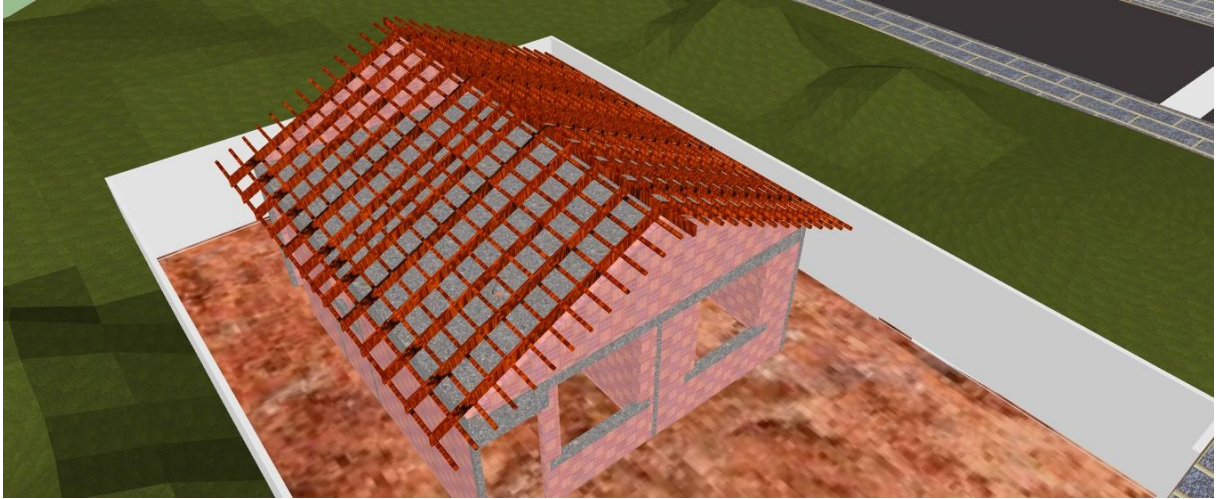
Detalhe madeiramento do telhado – vista 1.
